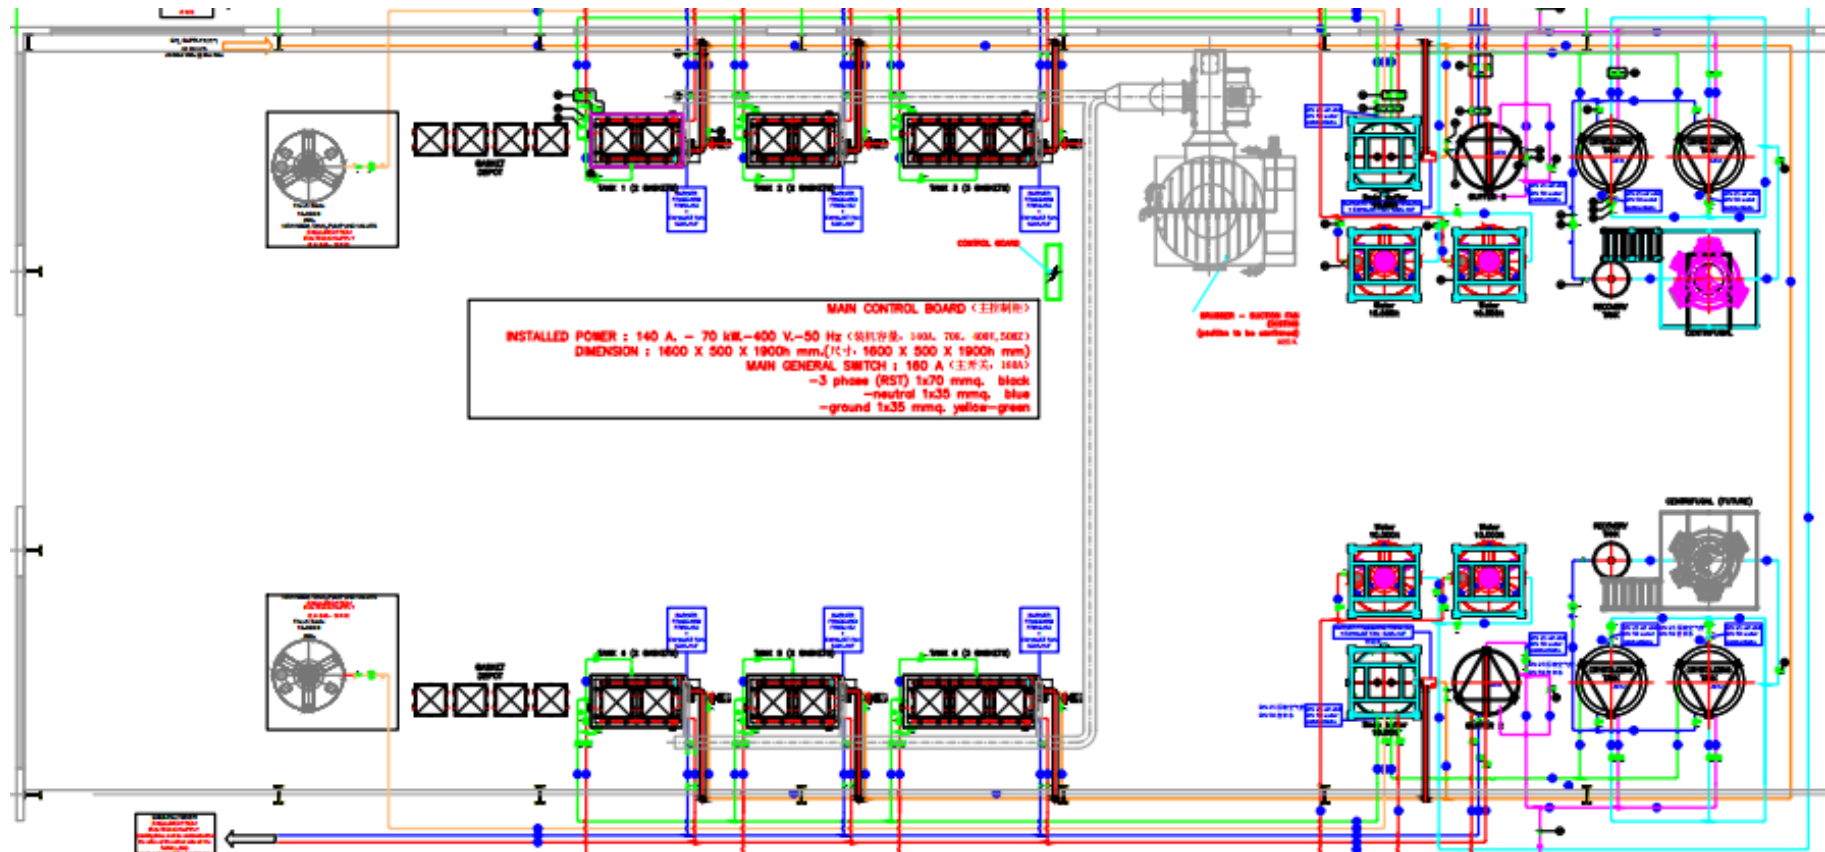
本次技改项目氢氧化铝生产车间平面布置图
